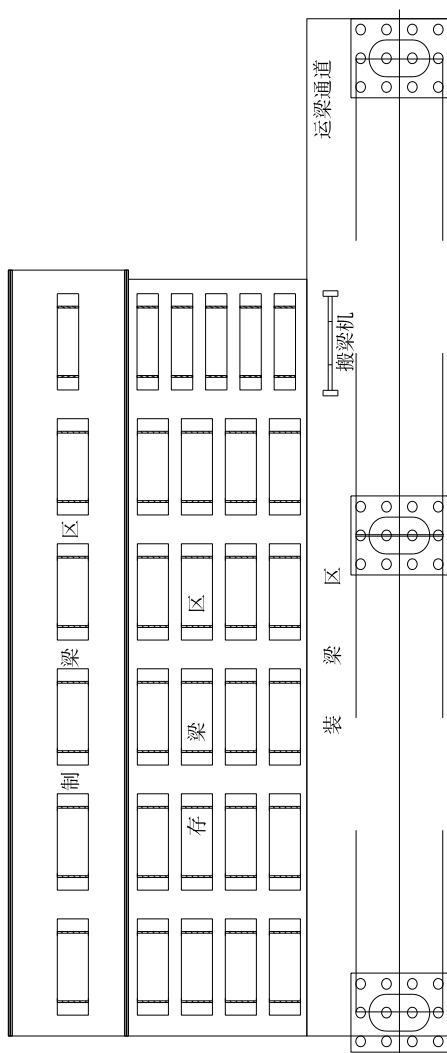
搬梁机搬梁、轮胎运梁车出梁的节段梁预制场平面布置图
